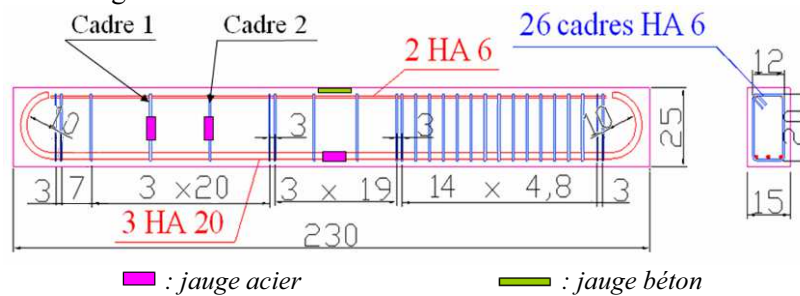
Plan de ferrailage des poutres sous dimensionnées à l'effort tranchant et positionnement des jauges de déformations sur l'acier et le béton
